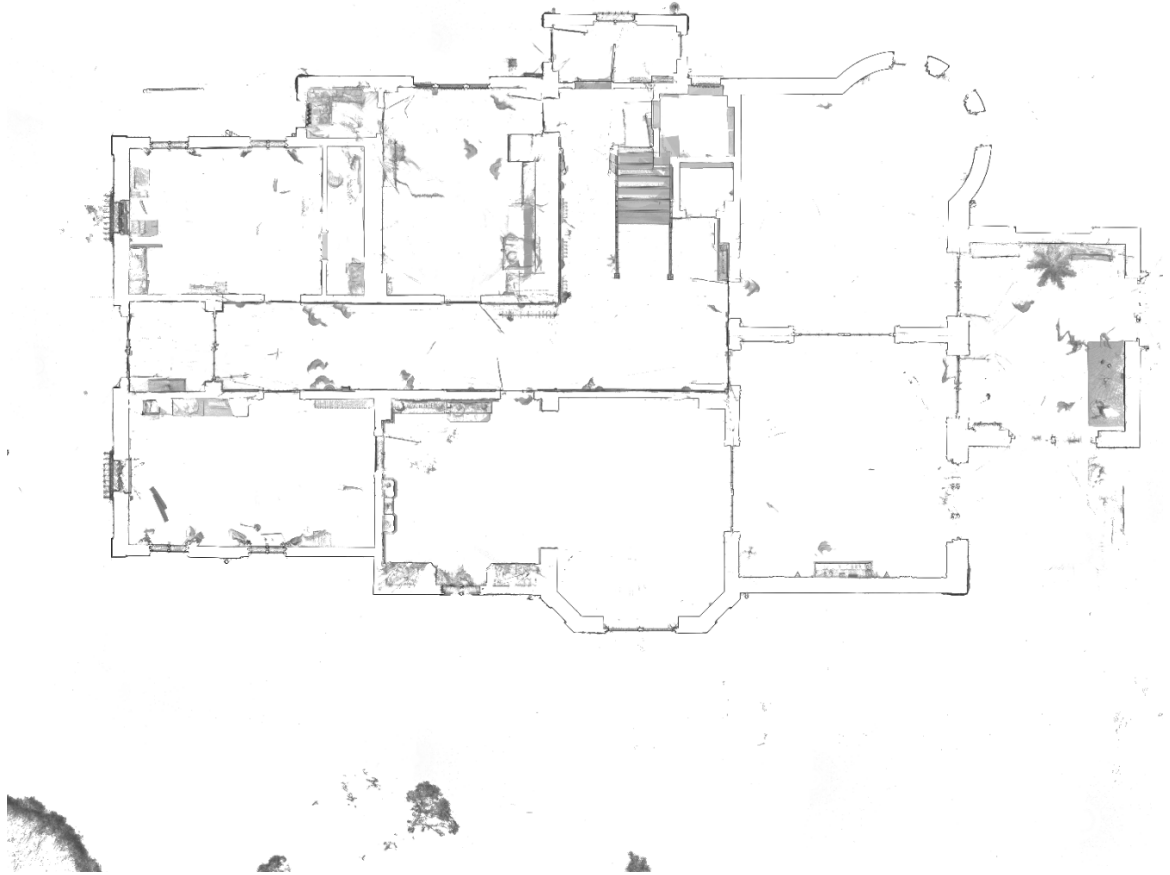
Ejemplo del resultado del corte en Planta a 1.5m del nivel del suelo en PointCab. Planta Baja.
